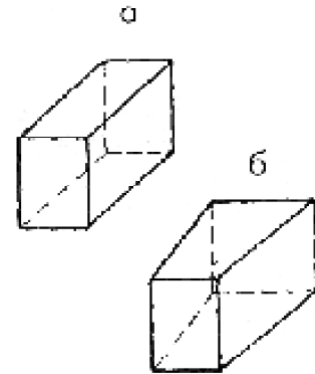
Форми каменів: а - для прямолінійного; б - для криволінійного контуру виробки
